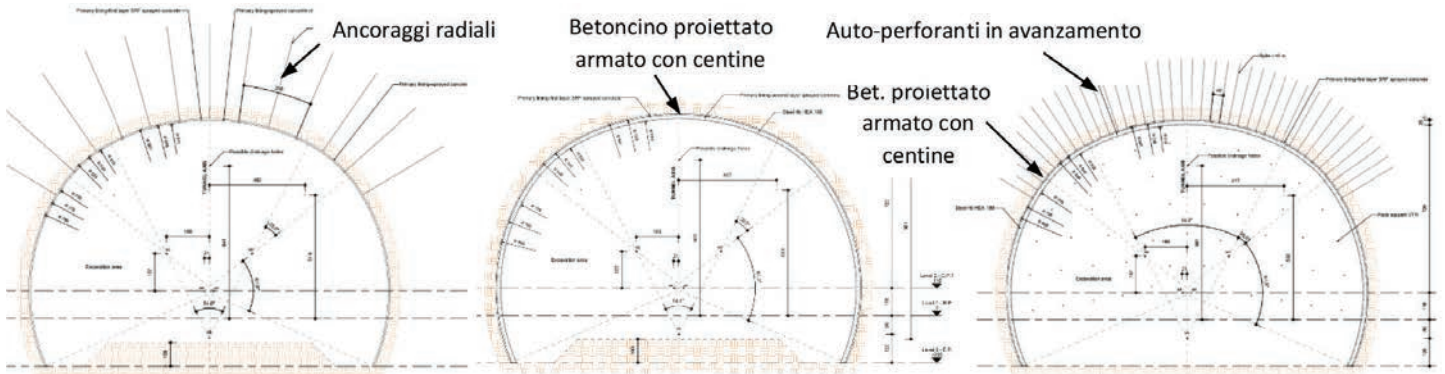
(a) Sezione di scavo Good/Fair/Poor; (b) sezione di scavo Very Poor; (c) sezione di scavo Extremely Poor.
